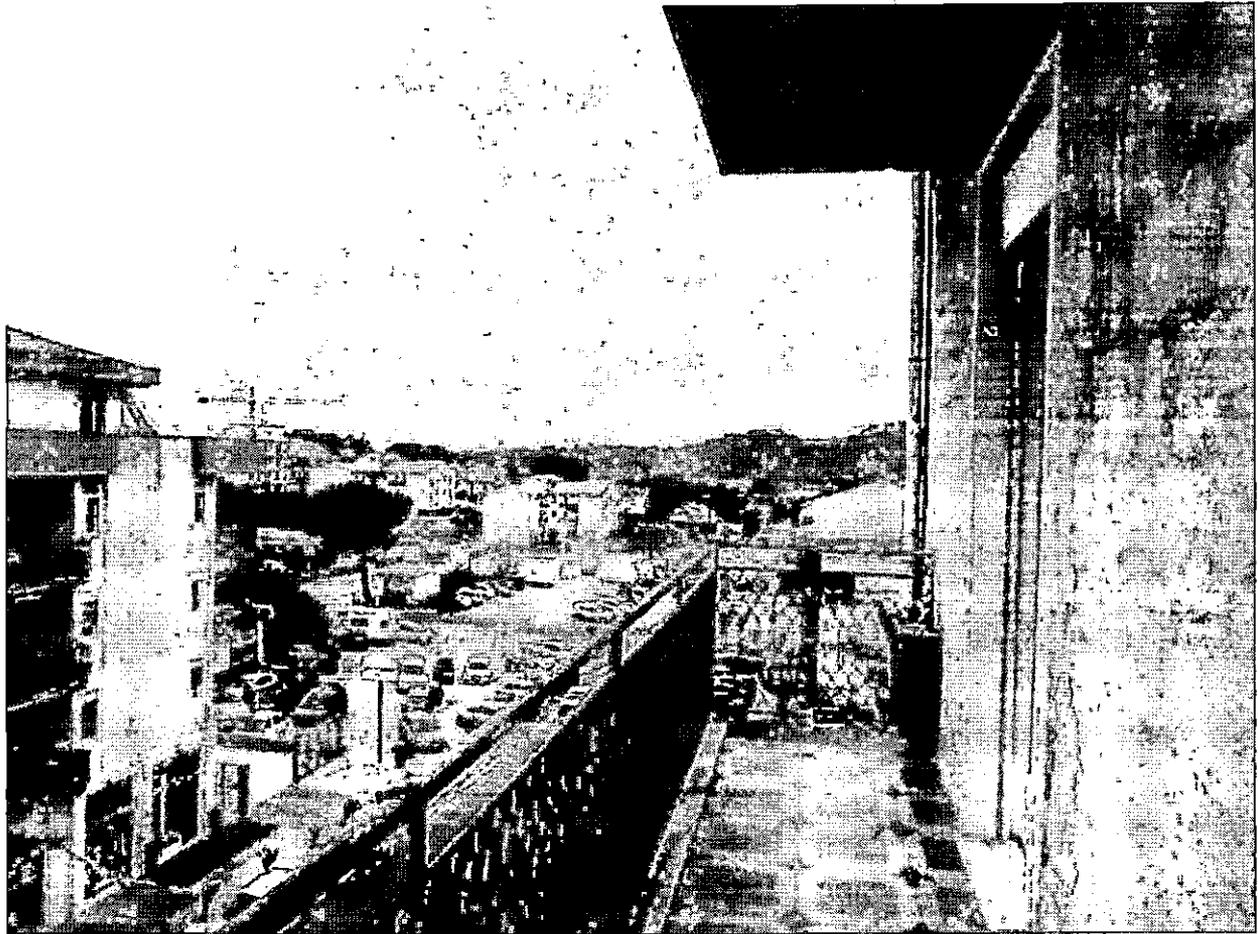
Foto dell'esterno lato sud Immobile 1 Sub 13
